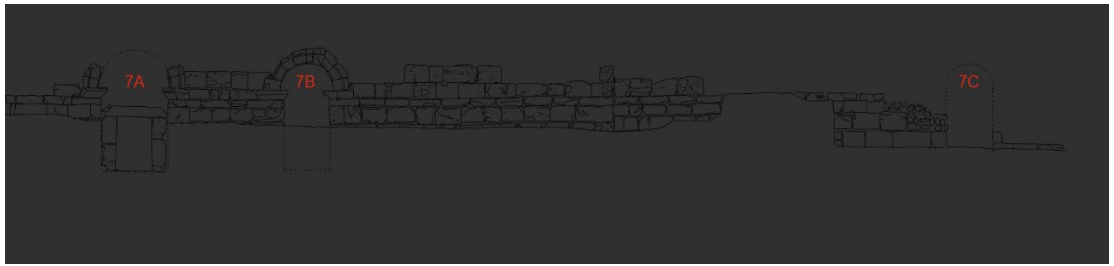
Tiyatro-Stadion Yapısı'nın tamamlanan plan çizimi.
